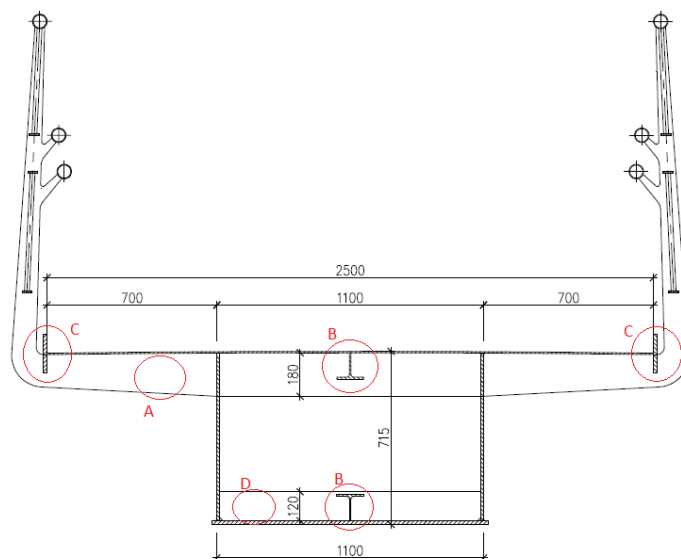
Secção transversal da ponte pedonal com concepção de viga em caixão [24].
